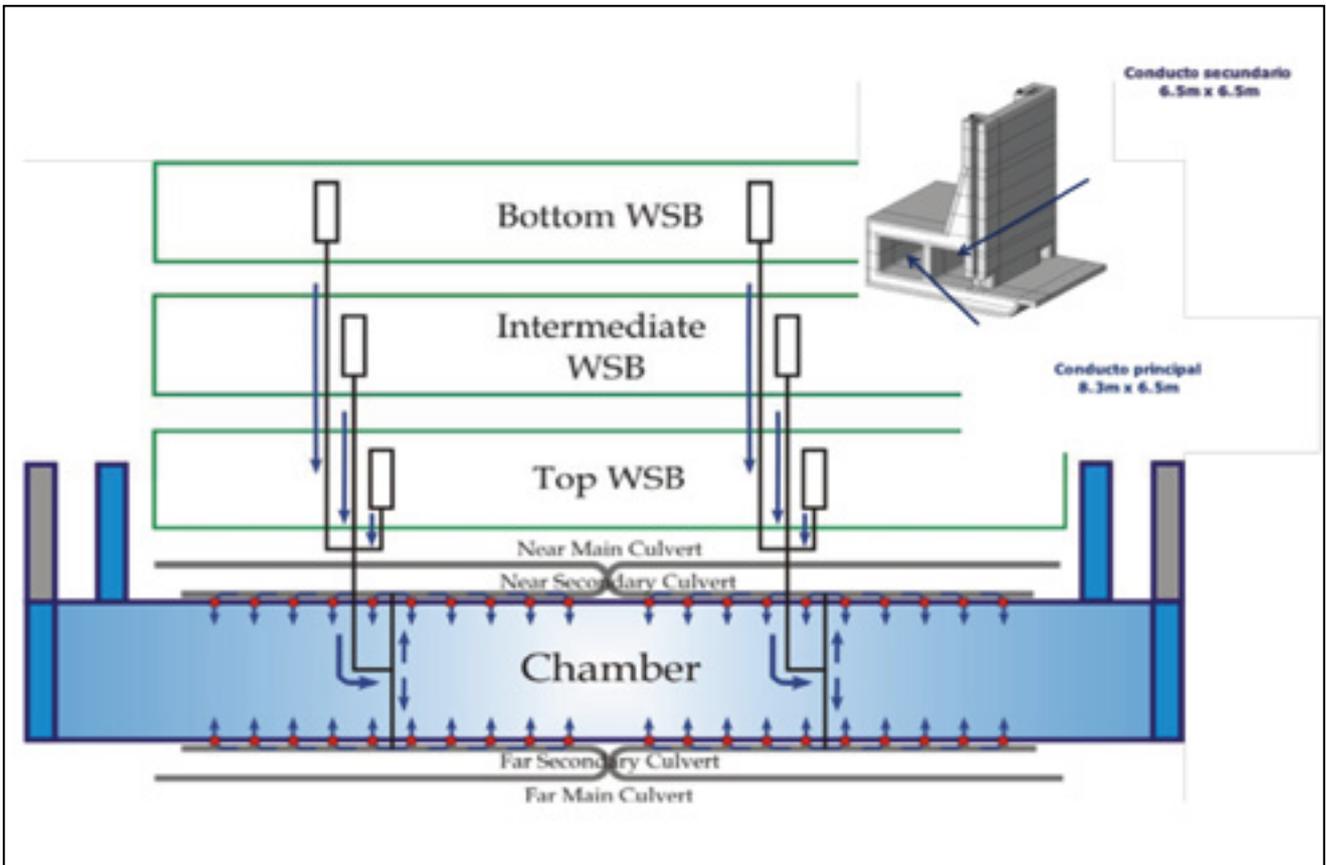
Vista en planta de los conductos principales (culvert) y las WSB (tinas de recuperación de agua).
